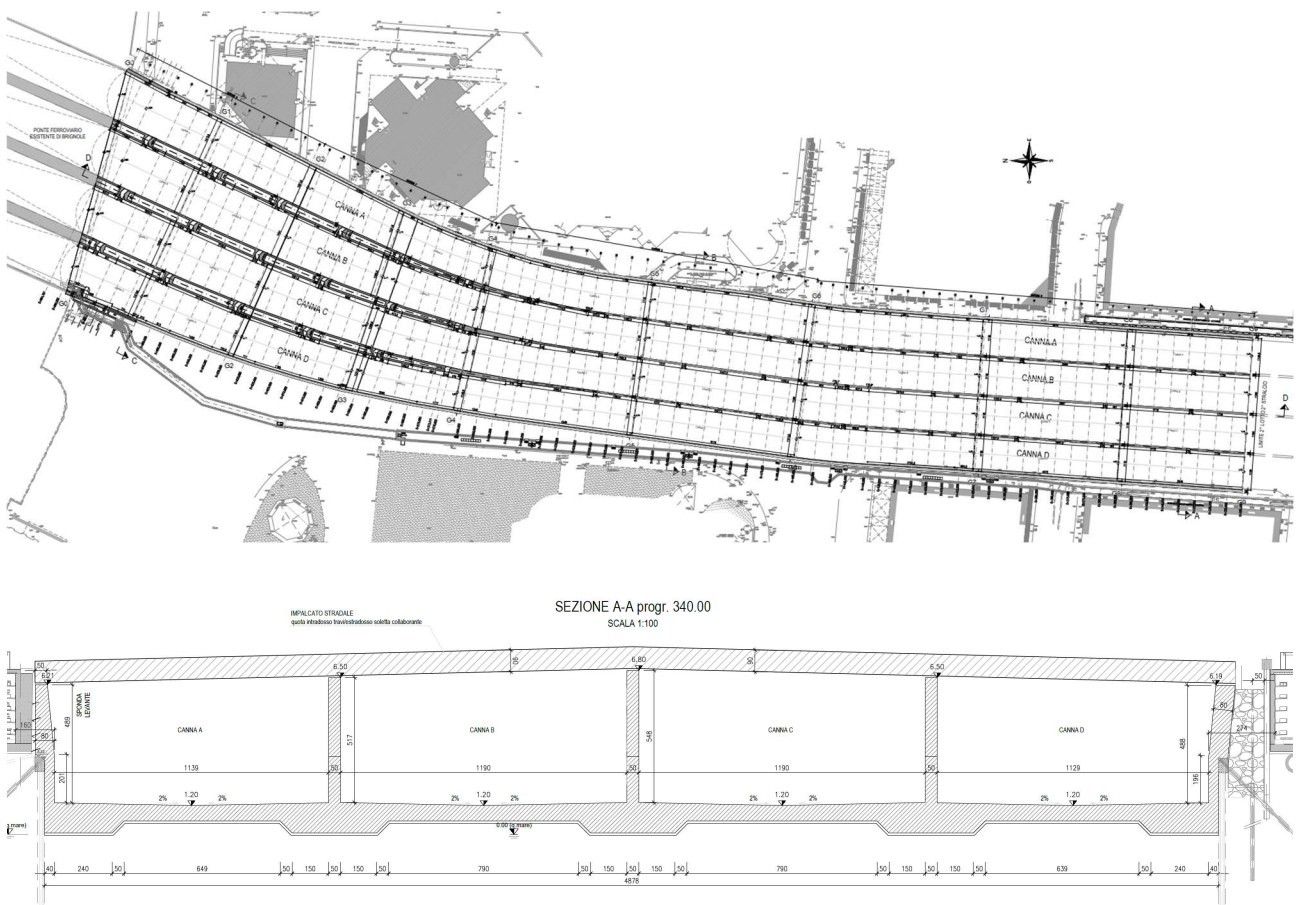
Pianta e sezione del tratto oggetto dell'intervento del 2° Lotto - 3° Stralcio.
